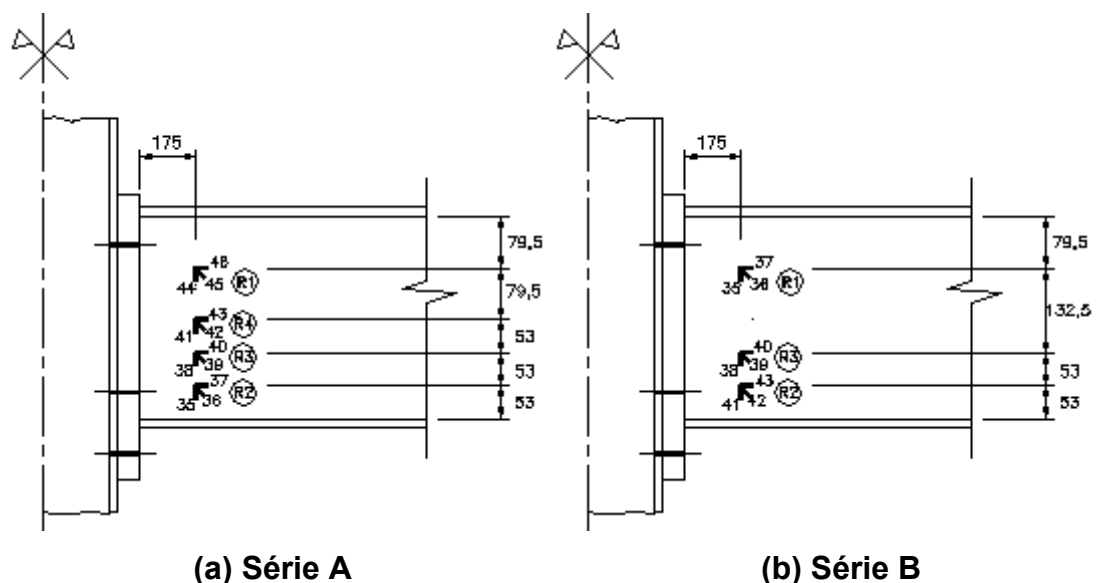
Rosetas na alma das vigas Grupo 2
